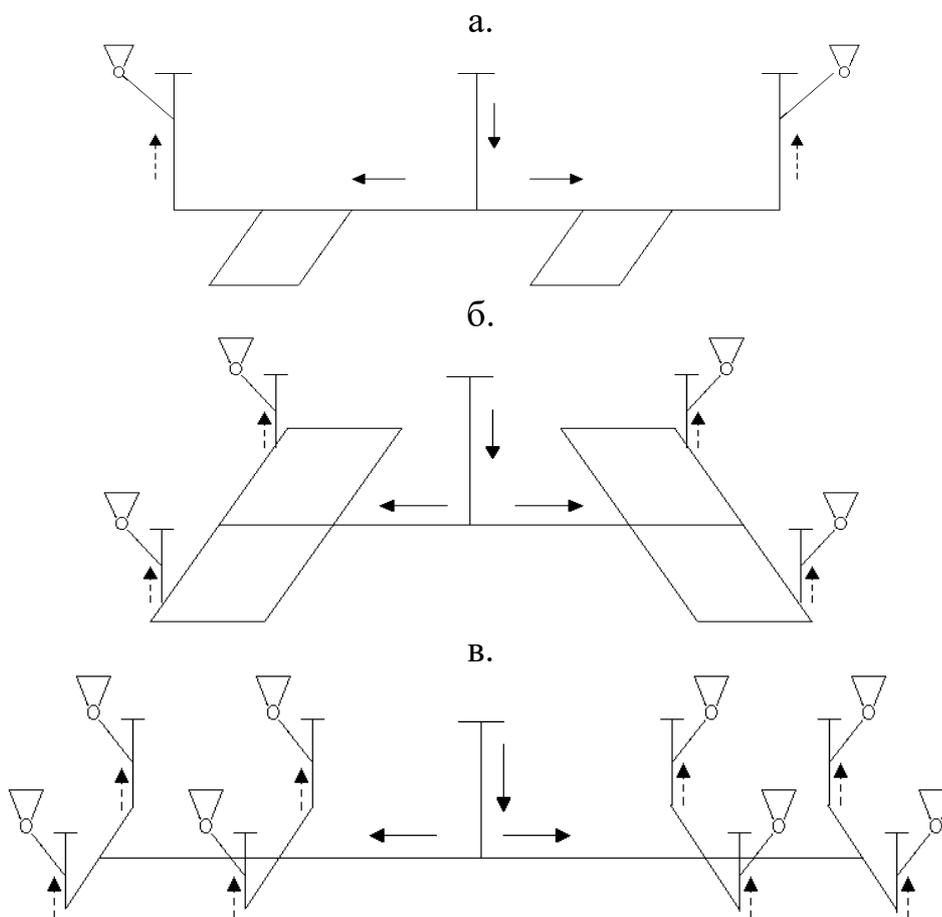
Фланговые схемы вентиляции шахт:
